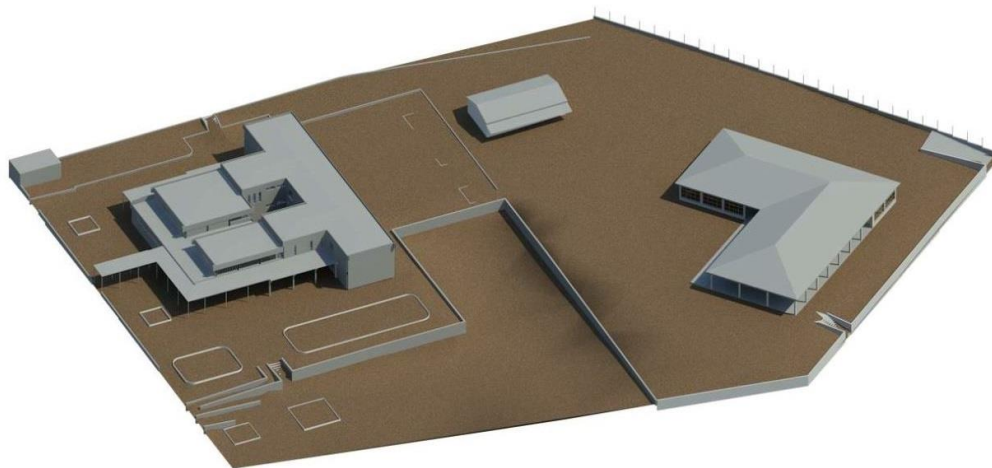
Centro Escolar – Situação existente (fonte: SE2P)
